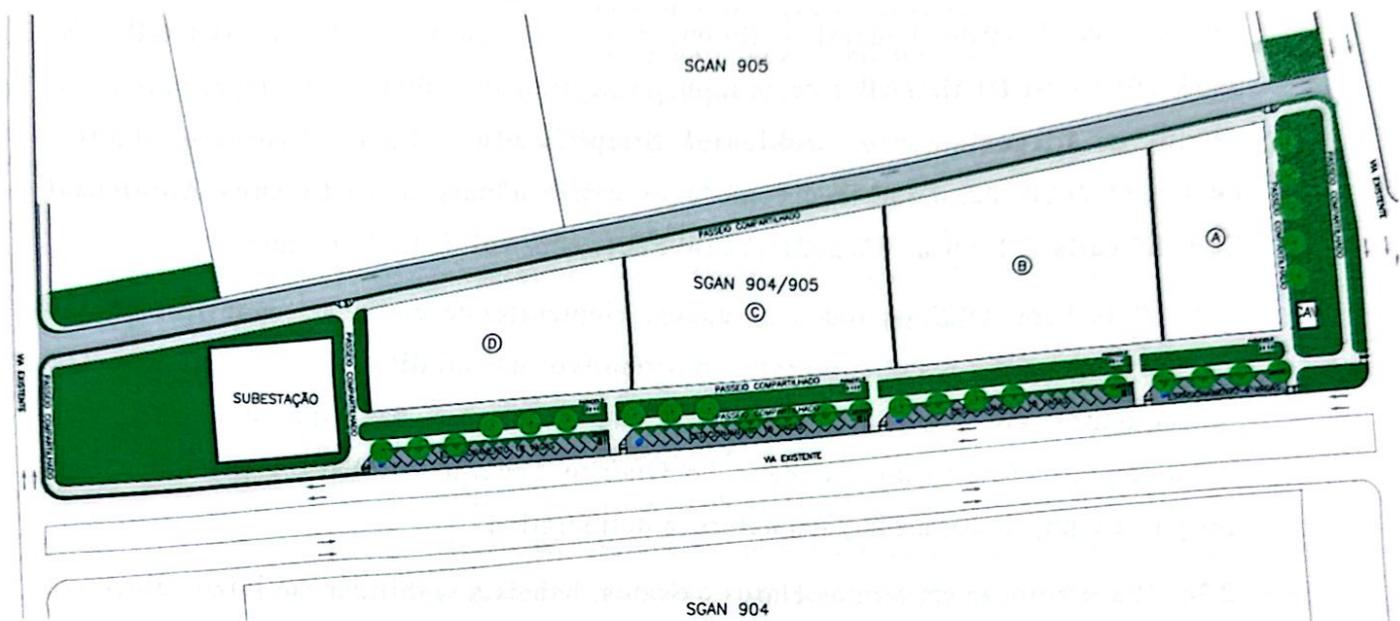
Croqui com os lotes criados (A, B, C e D) e relocados (Subestação e CAV)
